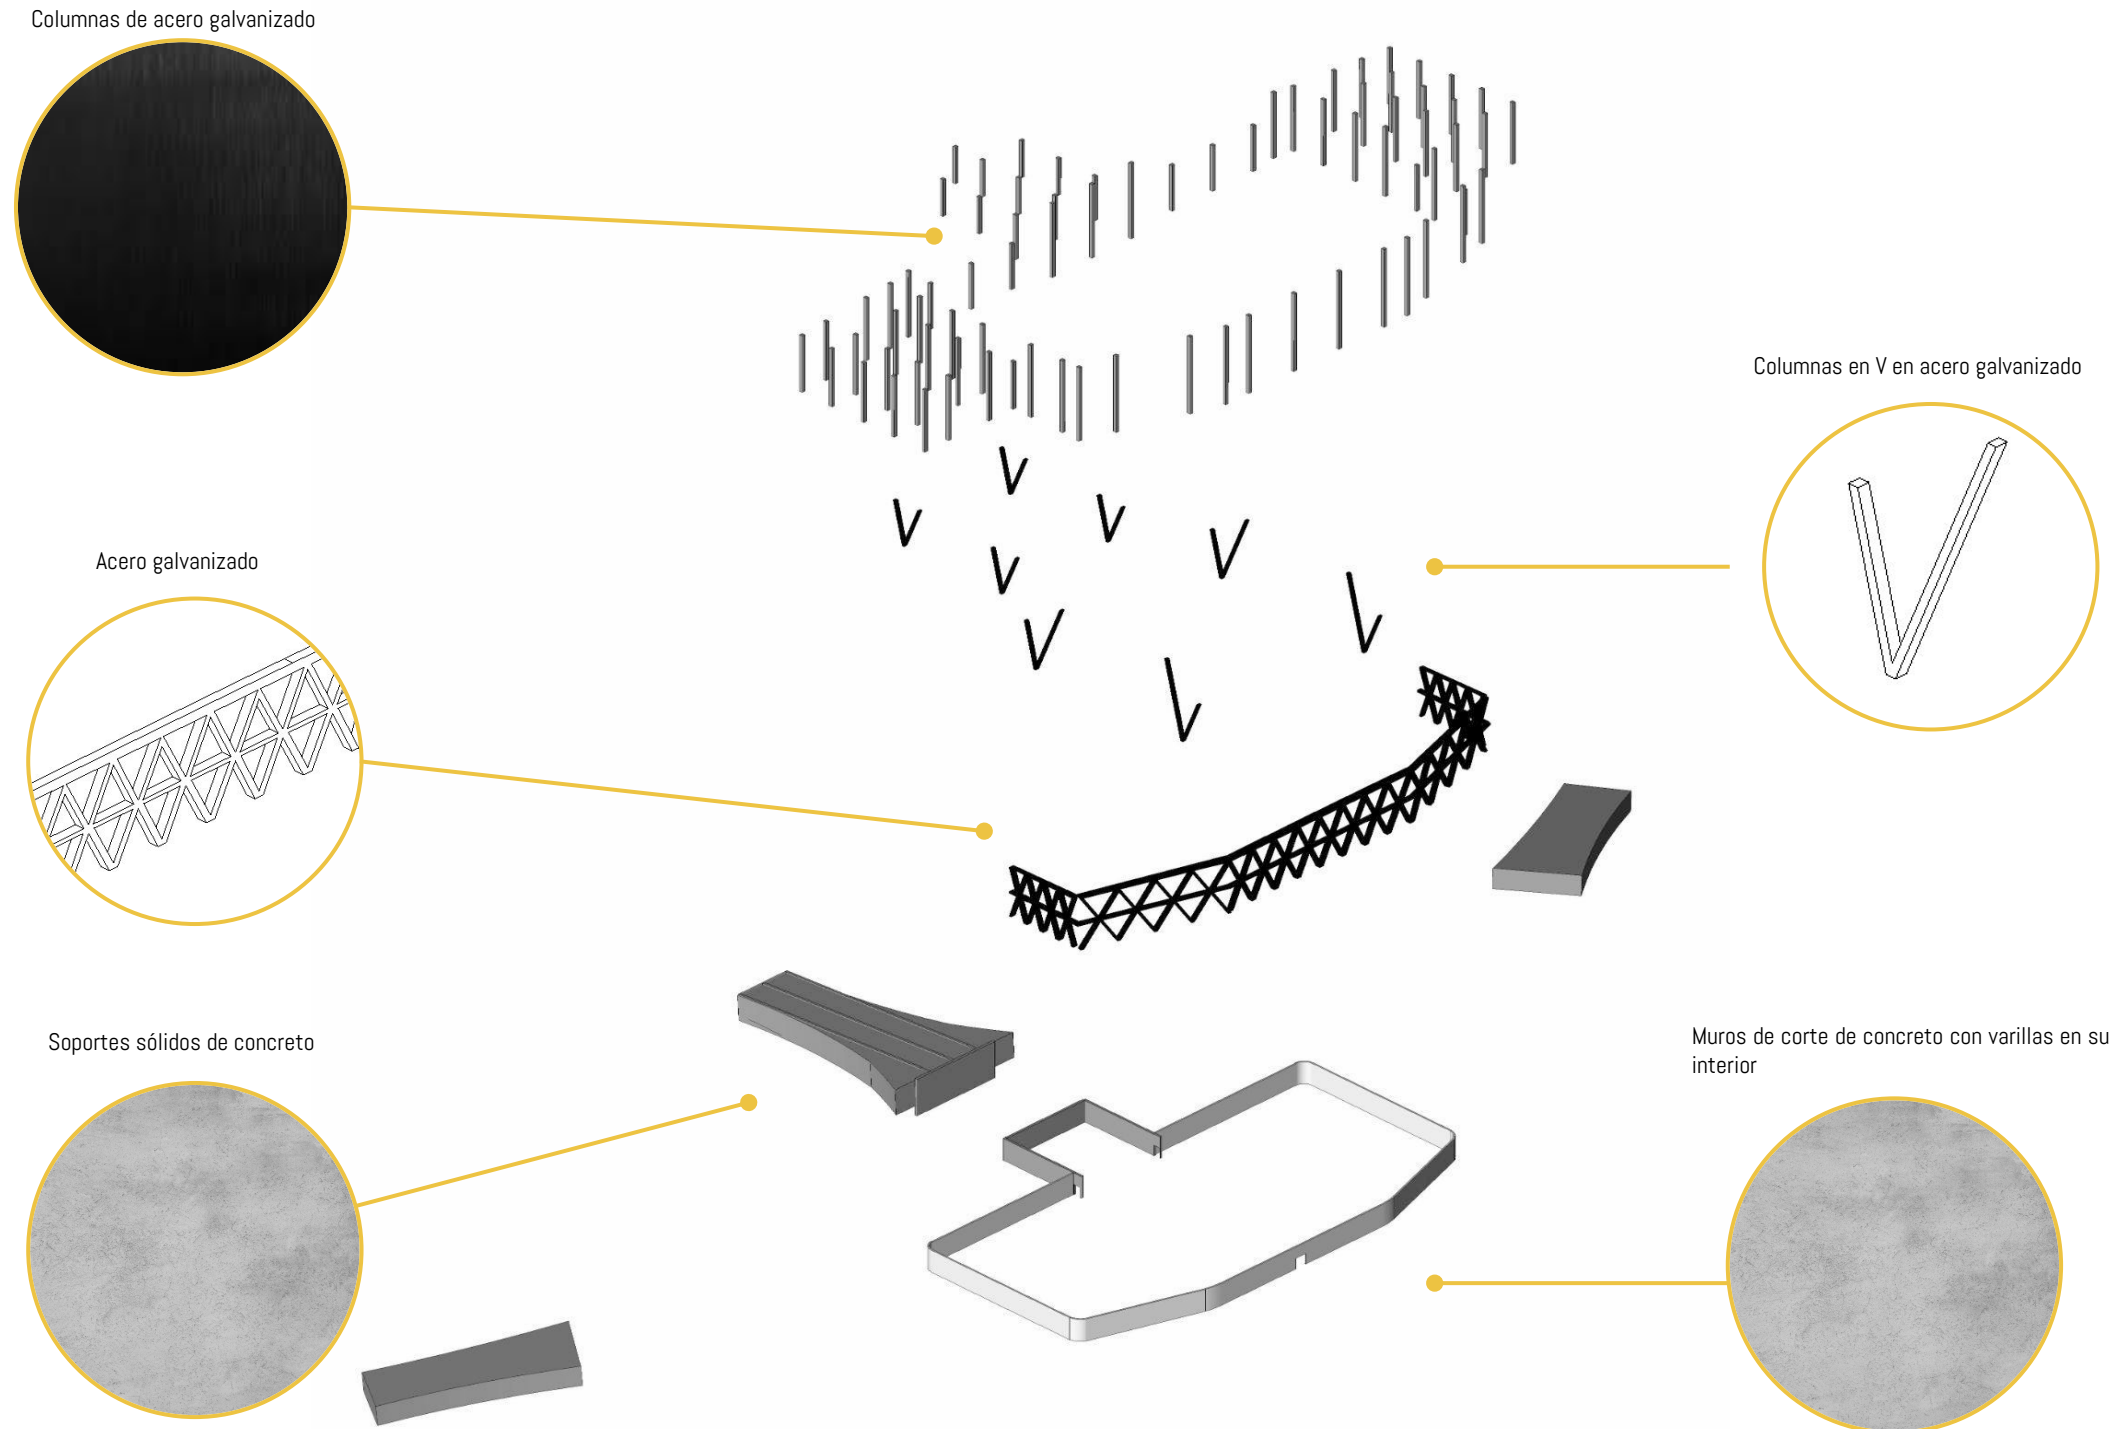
Materialidad estructural de elementos verticales. Elaboración propia
